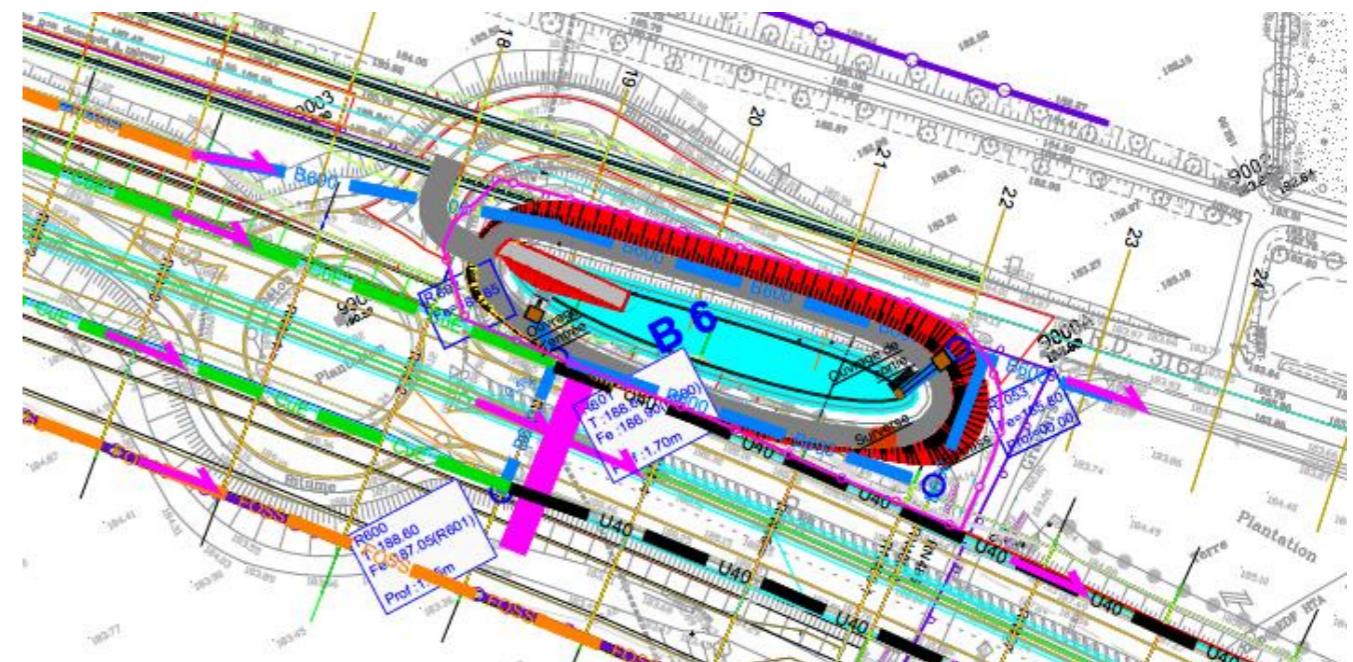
Plan d'assainissement du BR6 (source : SIR)
